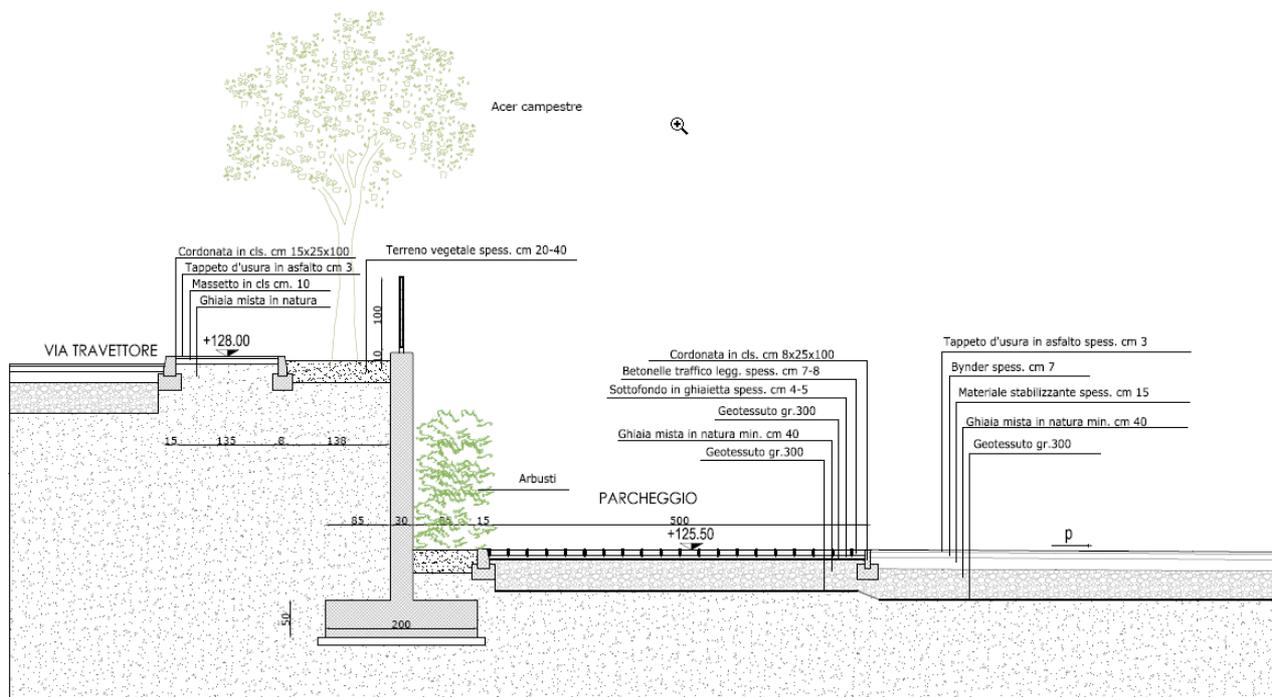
Particolare del parcheggio P9 lungo Via Travettore (Variante approvata - Tavola 6)
